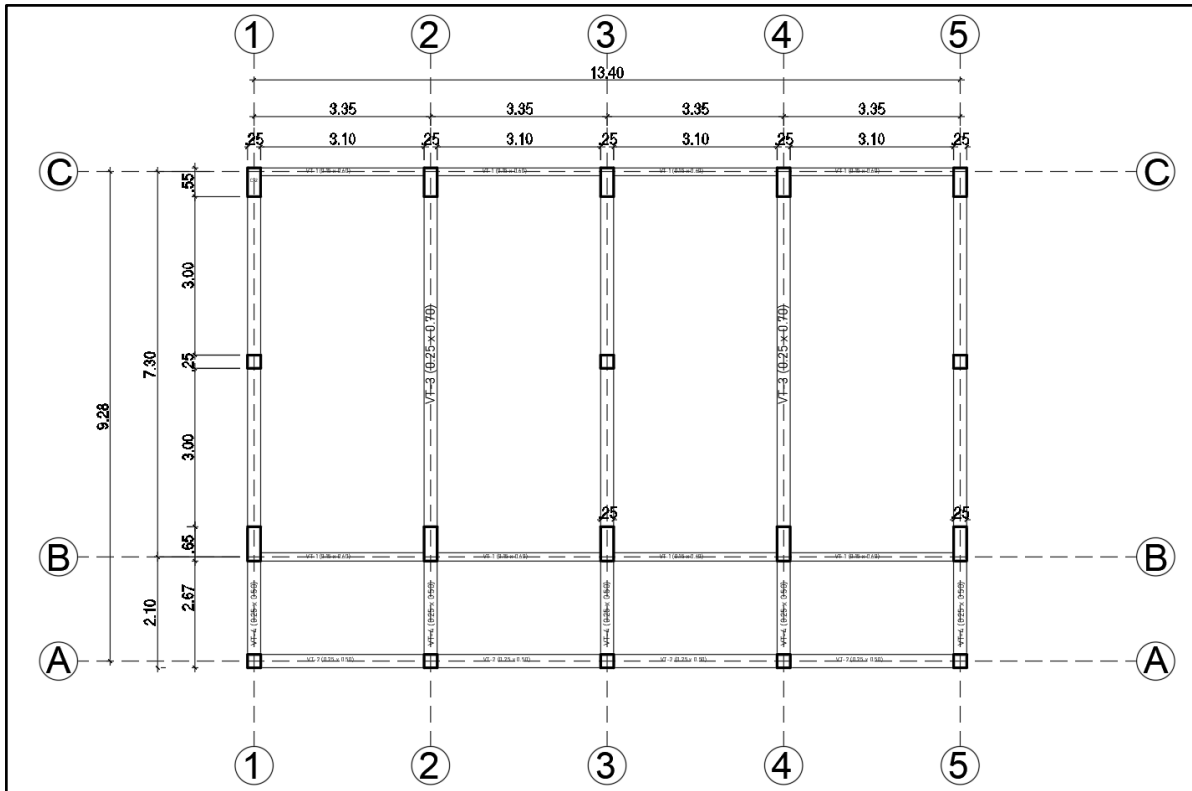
Planta de la Primera Tipología con 5 ejes.
